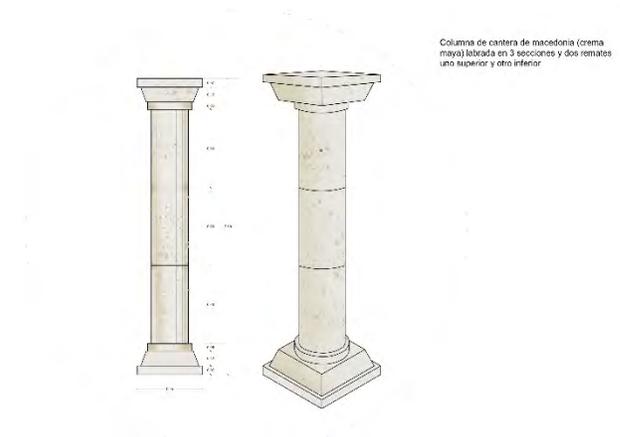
Detalle de columna restituida. Fuente: imagen propia de la autora.
